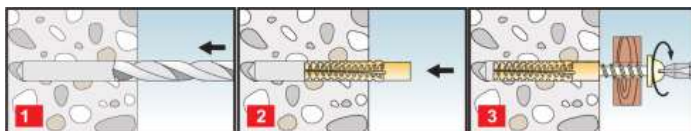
Установка дюбеля КФСТ.735322.095 и КФСТ.735322.096.
